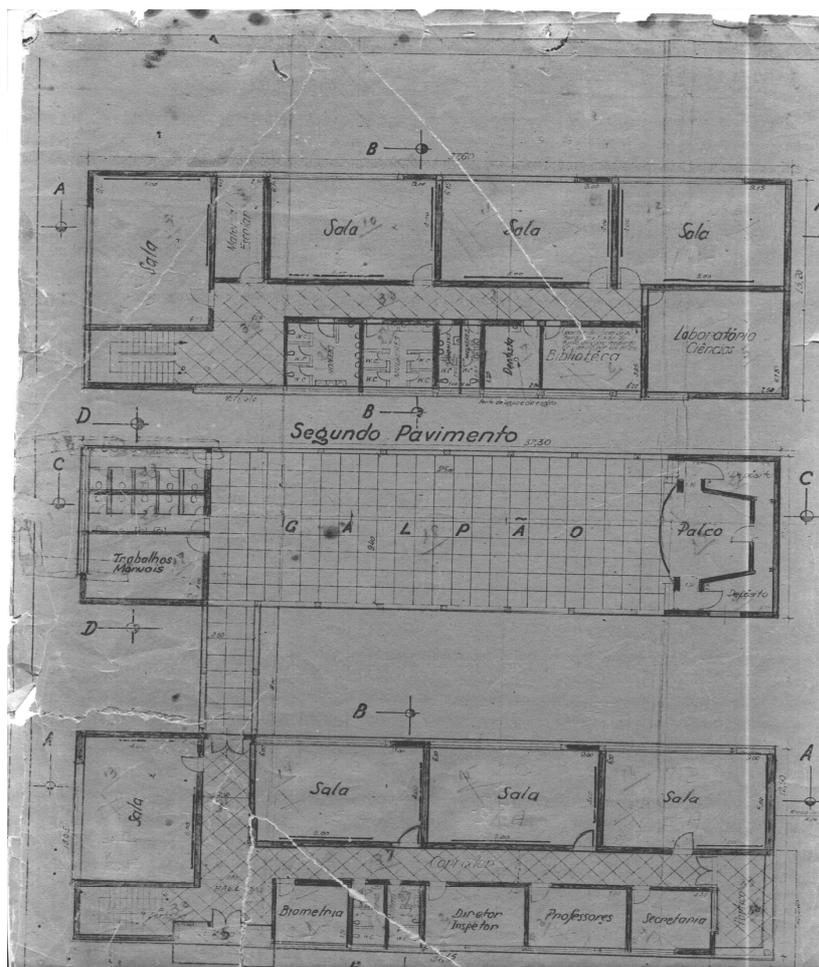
Cópia da planta baixa do Ginásio Estadual de Pilar do Sul
